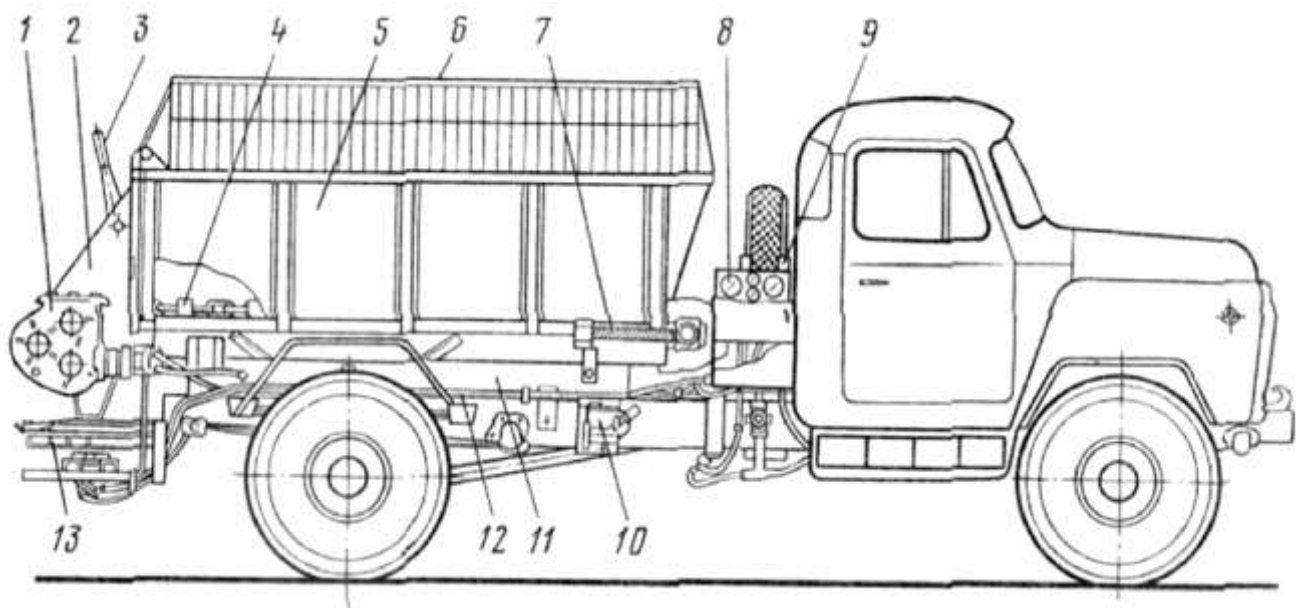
Разбрасыватель универсальный КО - 104А
